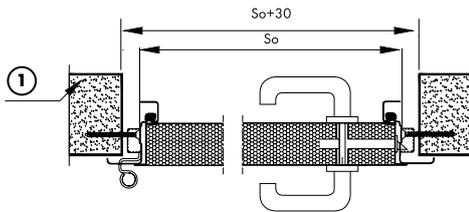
Montage einflügeliger Türen mit Eckzarge an der Stahlkonstruktion - Horizontalschnitt.
